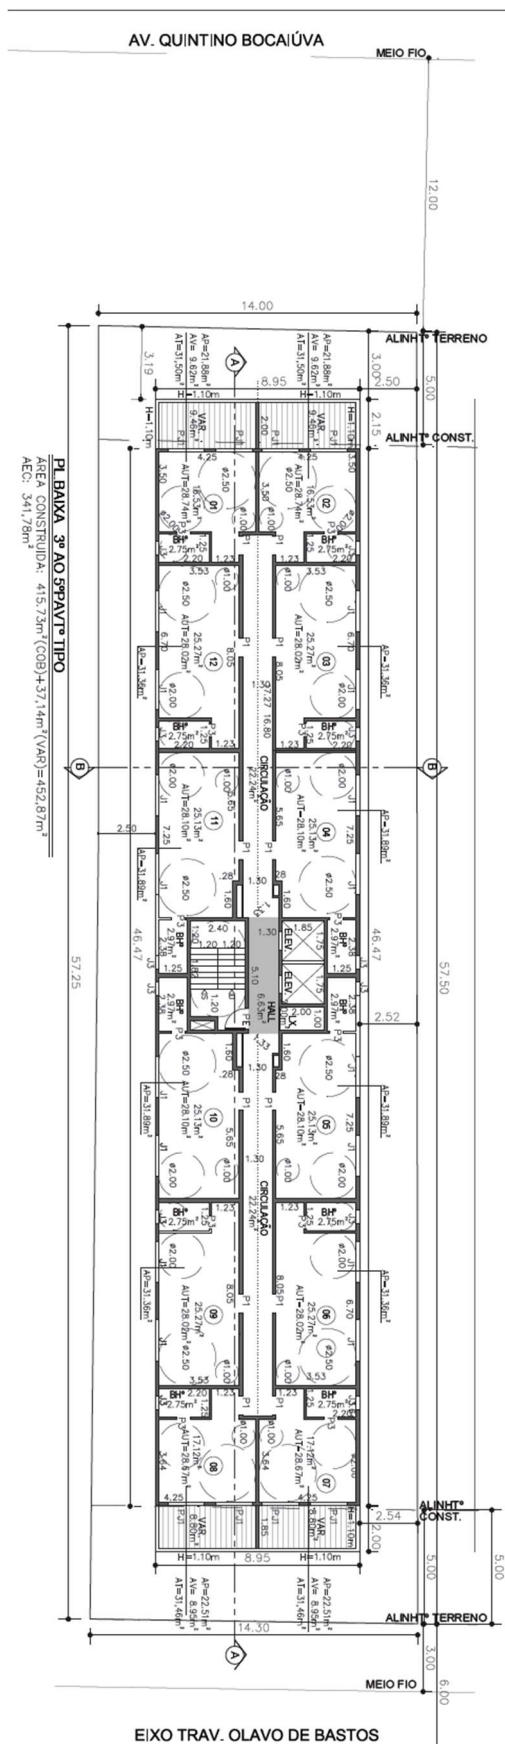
3º ao 5º pavimento tipo - Fonte: Projeto Legal
